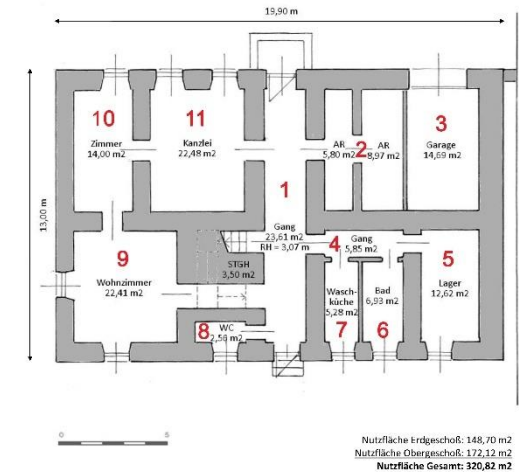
Grundriss Erdgeschoß mit nummerierten Räumlichkeiten, Pfarrhaus Winden am See.
